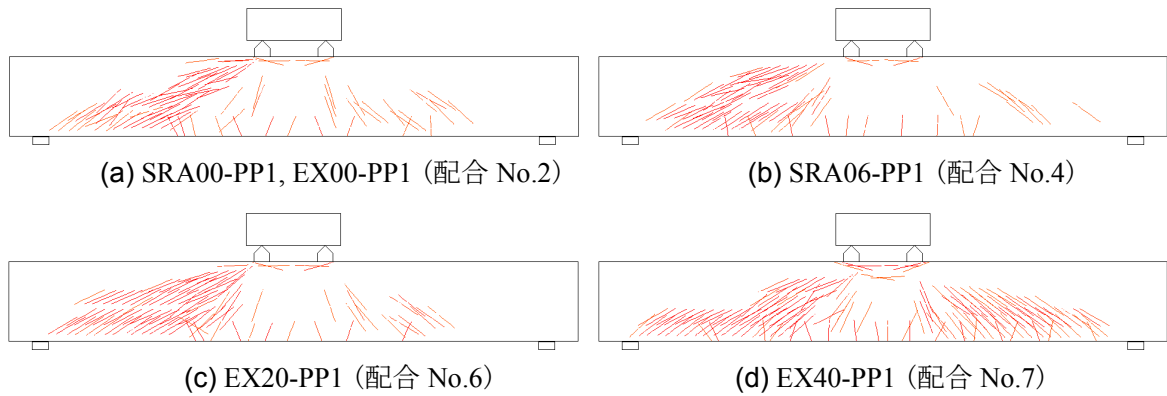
数値解析から求めた各 RC はりのひび割れ図
